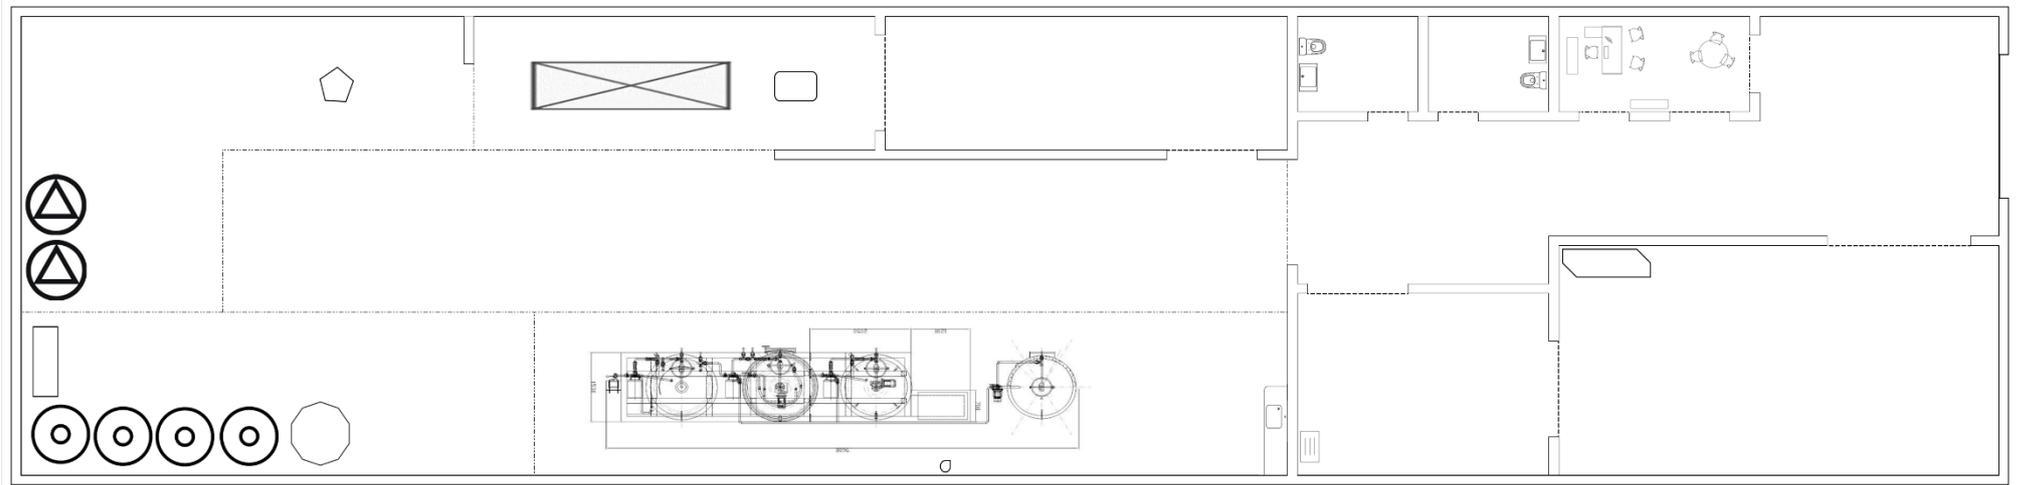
Plano en detalle de la bodega. Fuente: Elaboración propia
